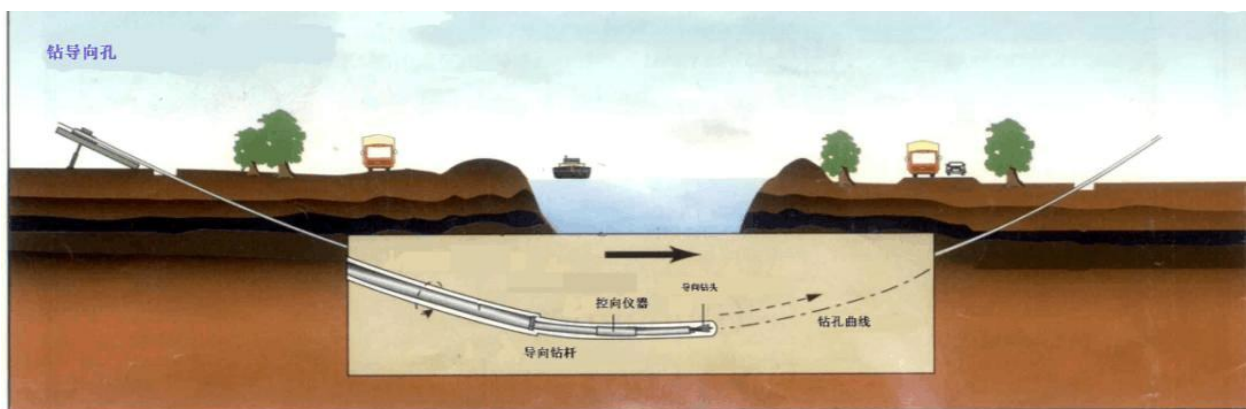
定向钻穿越施工钻导向孔过程断面示意图
